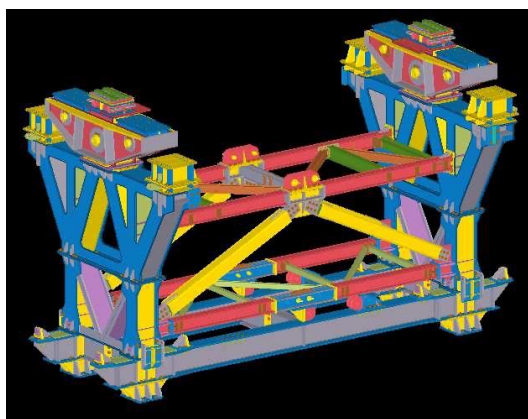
32 – Modelo 3D do pórtico do pilar.
